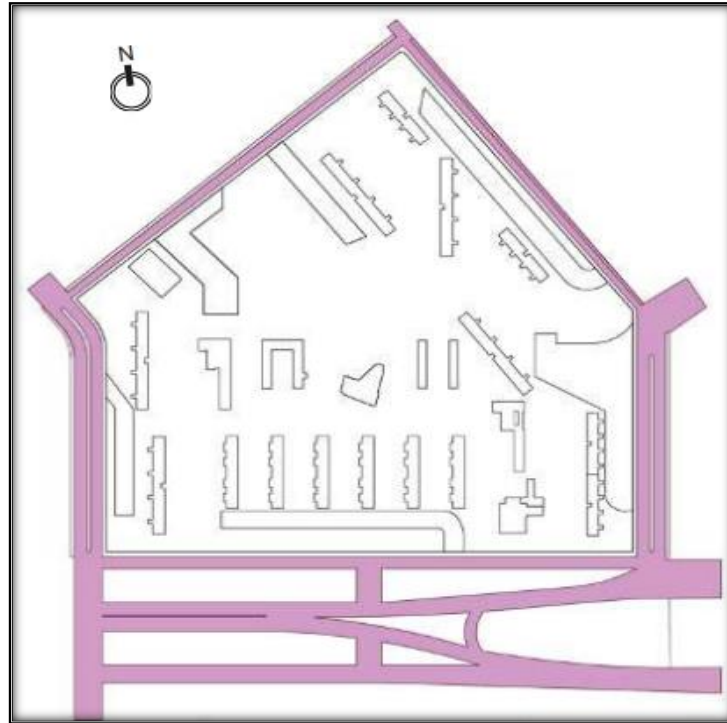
Planta del Centro Urbano Antonio Nariño. (Cancino J. C., 2021, pág. 100)
